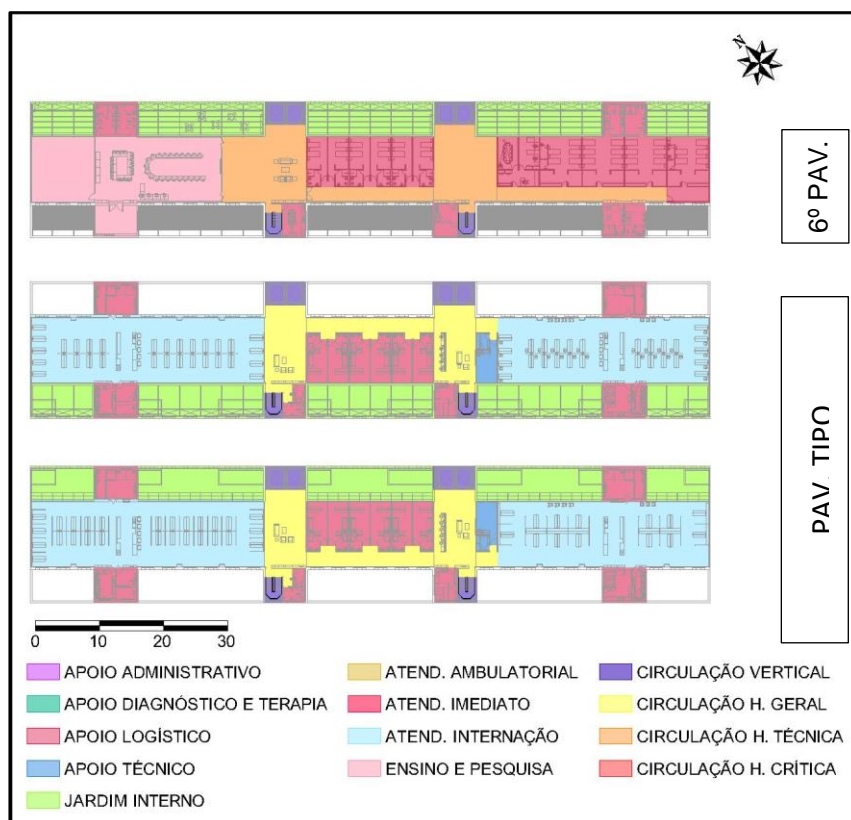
Setorização complexo principal, pavimento tipo.
